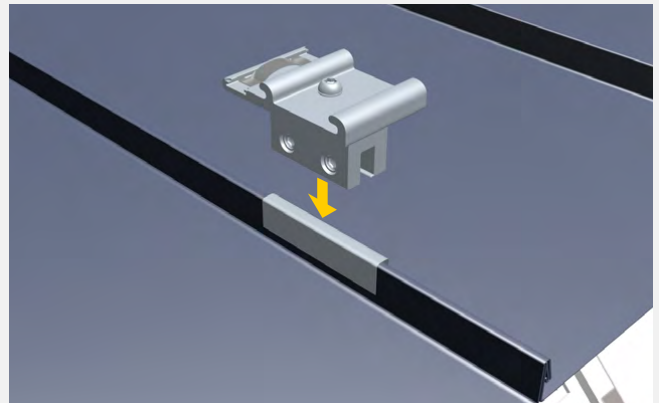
, Stehfalzklemme mit Edelstahlattel korrekt montiert
